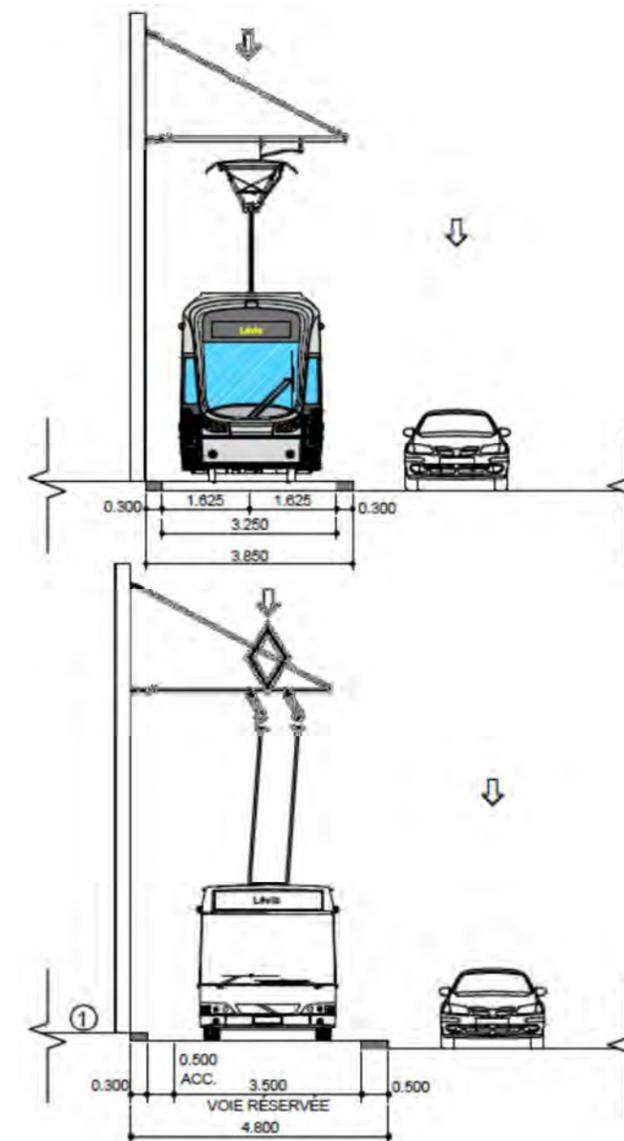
Coupe type 13 de 15 - SRB - Site propre standard - Insertion bilatérale
